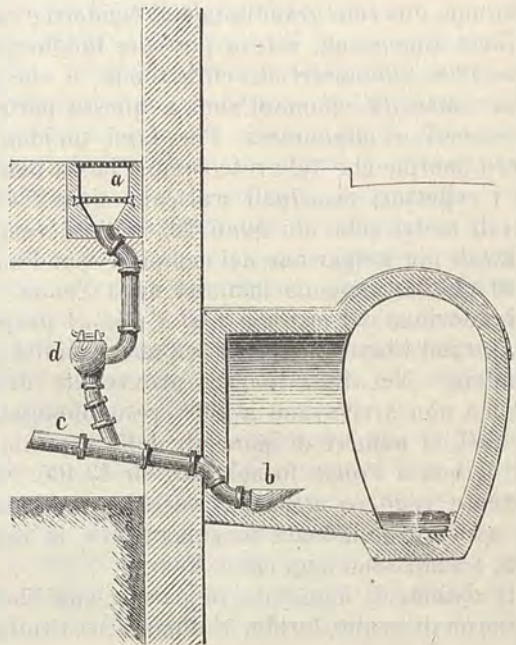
Disposizione regolamentare di un sifone stradale collegato direttamente coll'égout e con un condotto *c* di fognatura domestica.
